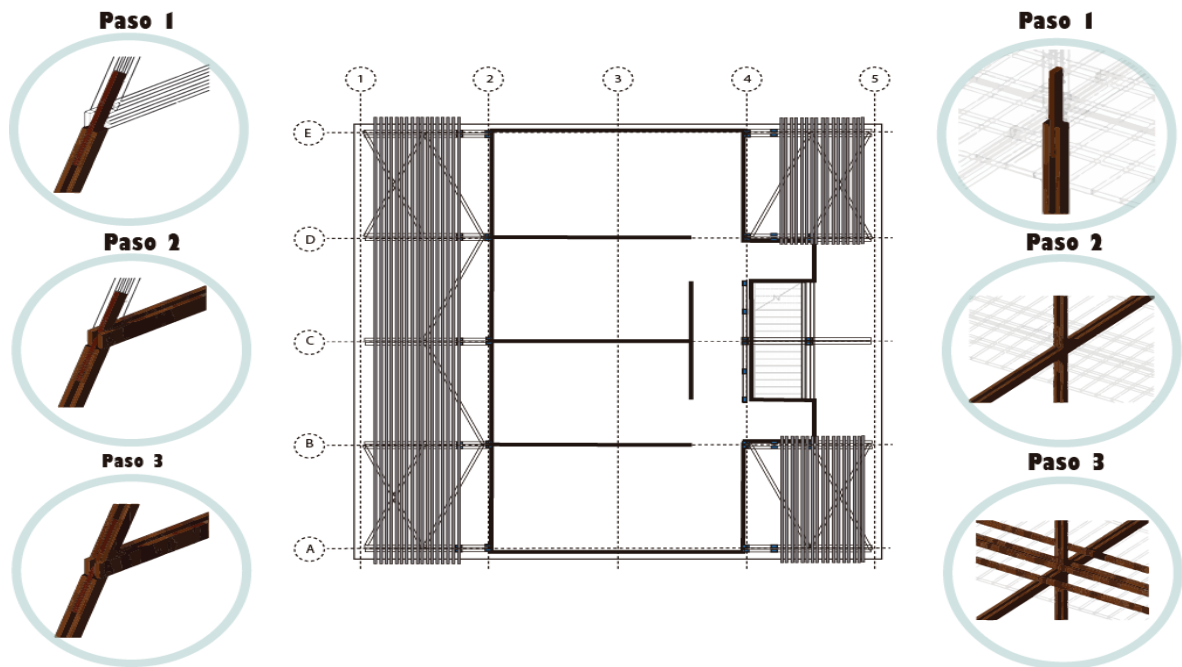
Juntas o amarres de construcción. Adaptado de (Franco, 2013)
